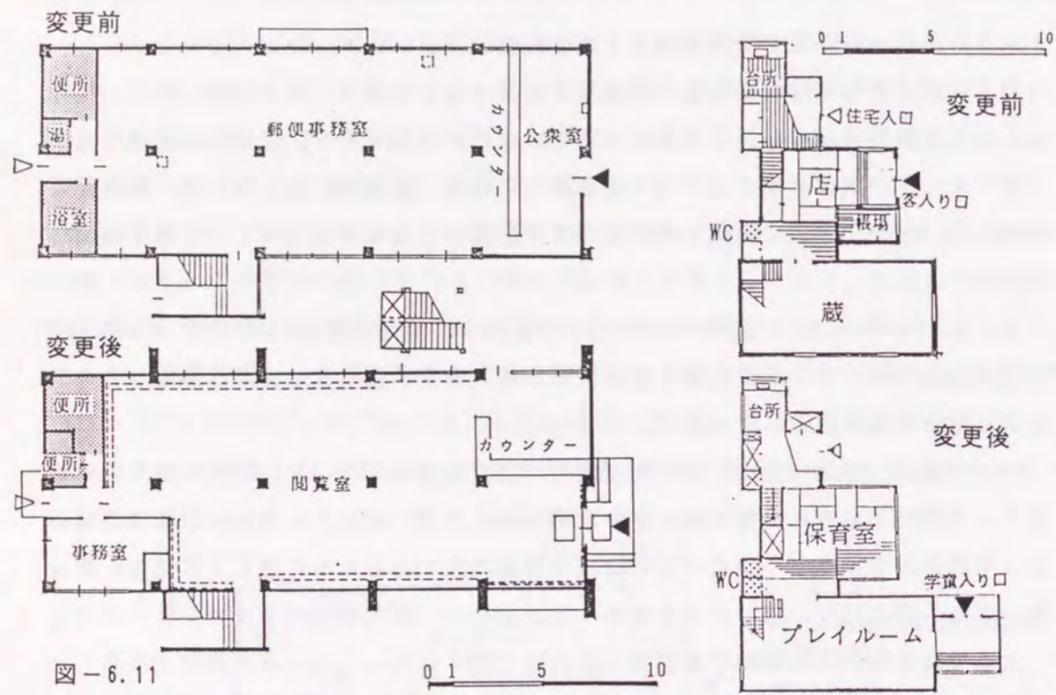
<84>日野図書館(旧日野郵便局)1階平面図
